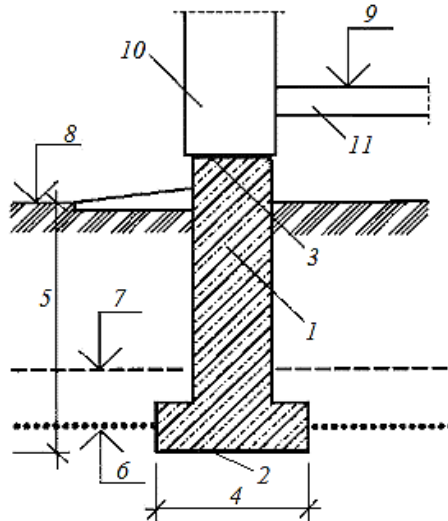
Елементи фундаменту: 1 – тіло; 2 – підшва; 3 – обріз; 4 – ширина підшови; 5 – глибина закладання; 6 – позначка глибини промерзання ґрунту; 7 – відмітка рівня ґрунтових вод (РГВ); 8 – планувальна позначка землі; 9 – позначка підлоги першого поверху; 10 – стіна; 11 – перекриття
